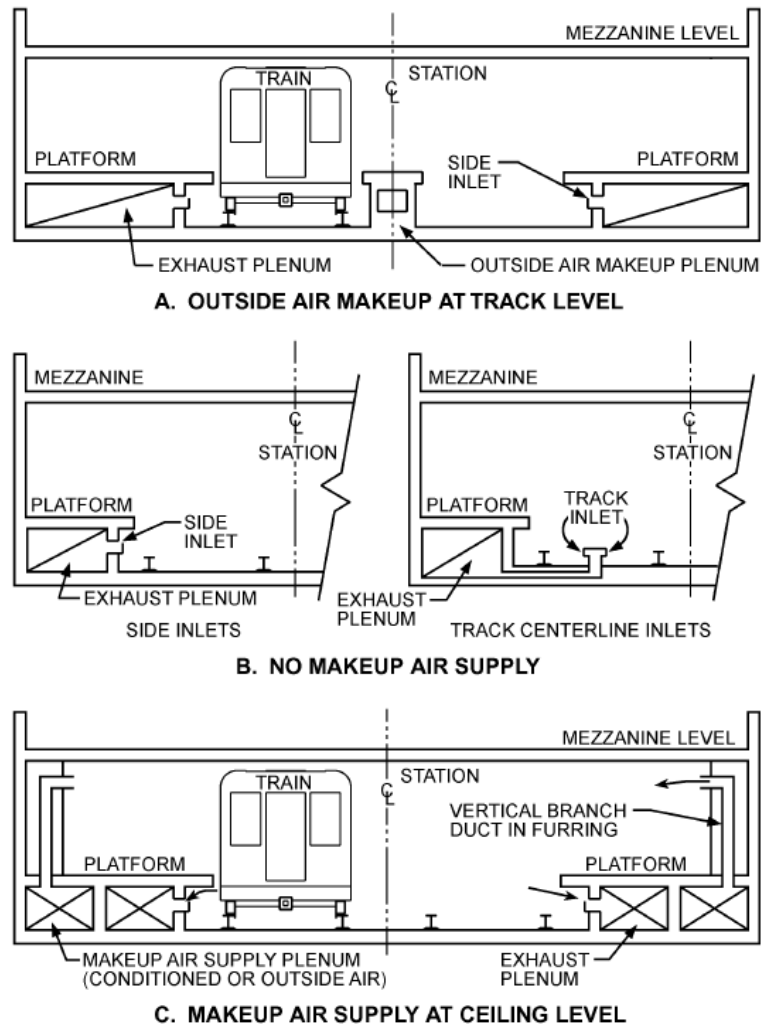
La ventilation des quais de tunnels ferroviaires (d'après ASHRAE (ASHRAE, 2011))
